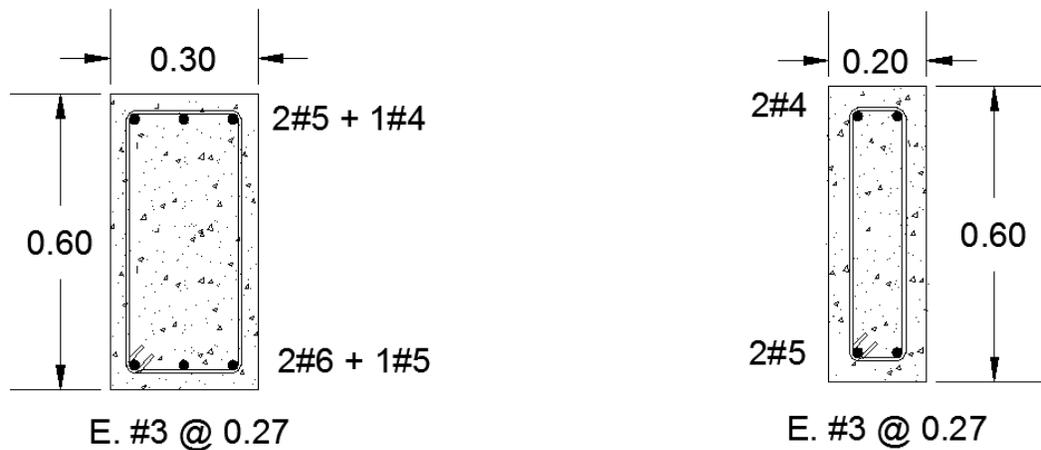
Sección de Vigas con refuerzo en flexión y compresión
